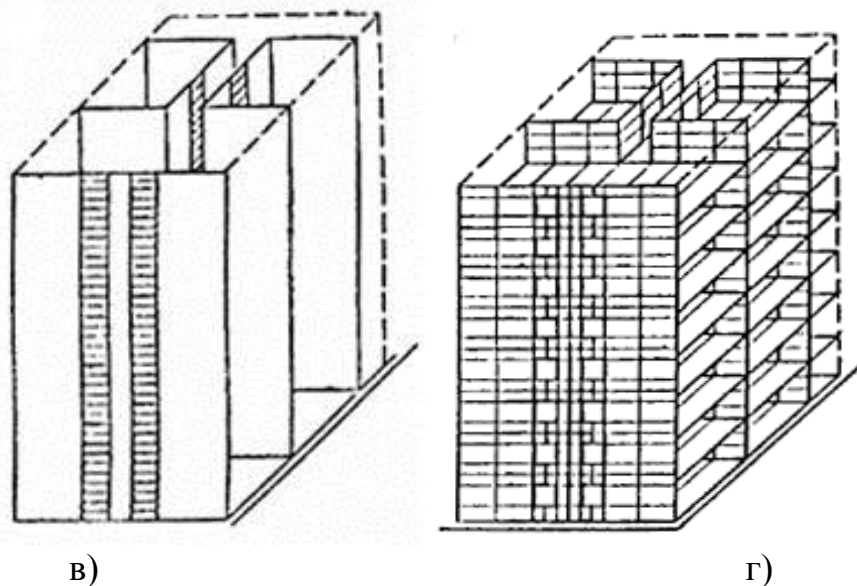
Трехмерные расчетные схемы бескаркасных зданий;
